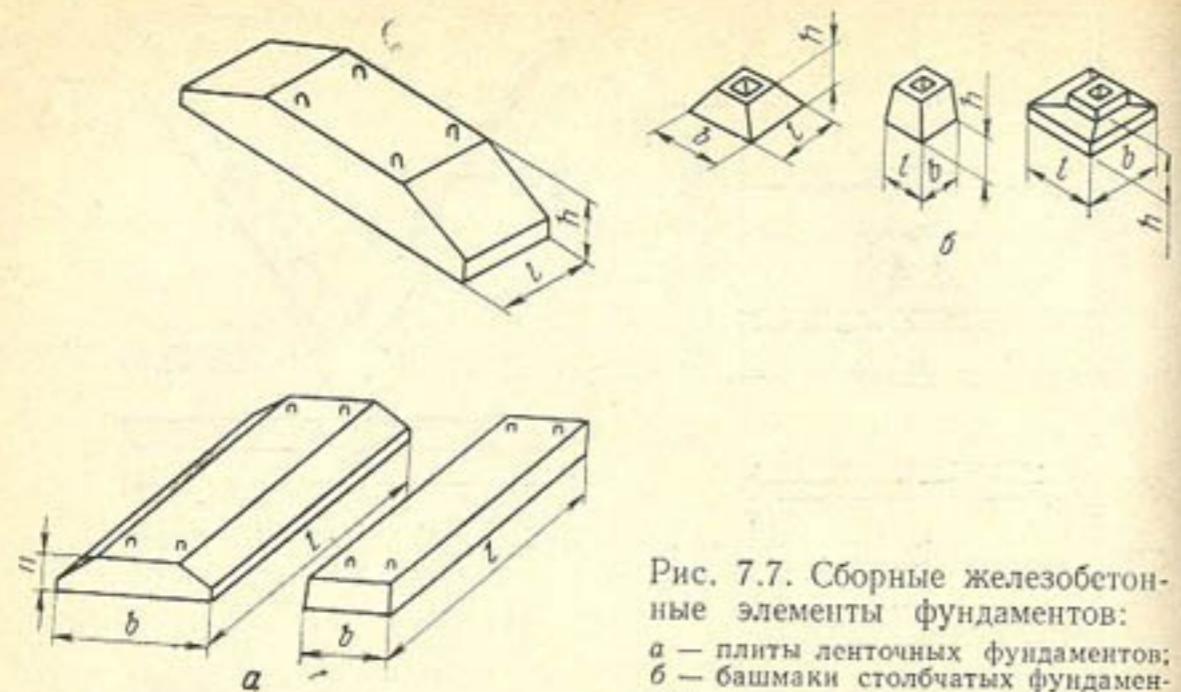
Сборные железобетонные элементы фундаментов:
